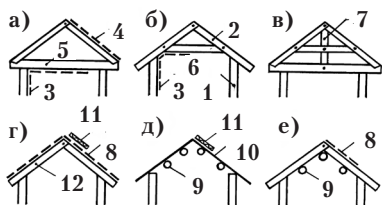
Типы стропил: а – висячие стропила с затяжкой, б – висячие стропила с ригелем, в – стропильная ферма, г – простые висячие стропила, д – наслонные стропила, е – комбинированные наслонно-висячие стропила. 1 – стены, 2 – висячие стропила, 3 – обшивка вагонкой, 4 – горизонтальная обрешетка, 5 – затяжка (балка перекрытия), 6 – ригель (перекладина), 7 – бабка, 8 – обрешетка из вагонки, набитая строганой
